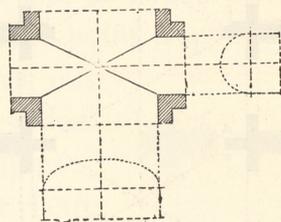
Voûte d'arête cylindrique sur plan rectangulaire.
